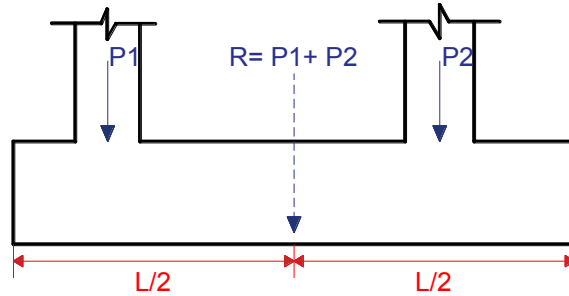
ZAPATAS COMBINADAS CON COLUMNAS CENTRADAS.
